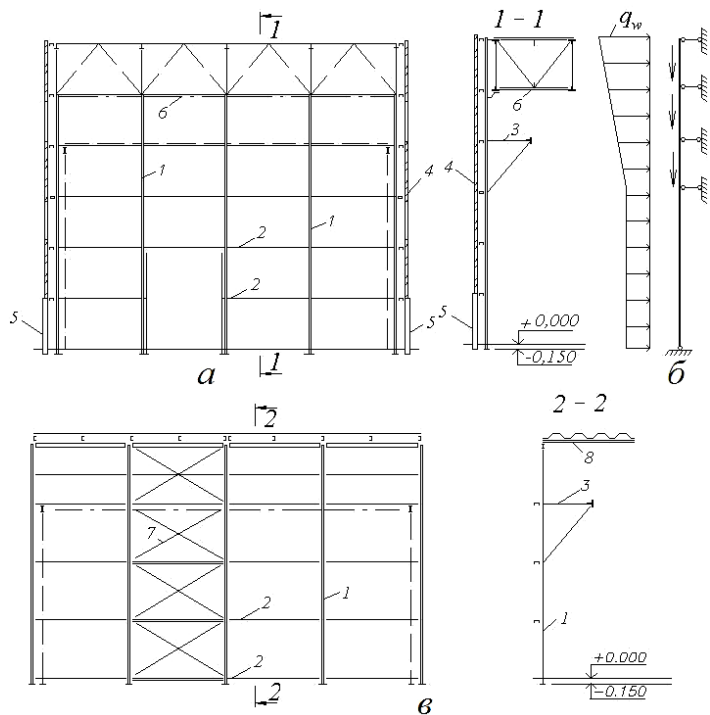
Торцевий фахверк: а – схема самонесучого фахверка; б – розрахункова схема стояка; в – схема несучого фахверка; 1 – стояки фахверка; 2 – ригелі фахверка; 3 – перехідна площадка; 4 – стінове огороження; 5 – цокольна панель; 6 – в'язі по нижньому поясу ригелів; 7 – вертикальні в'язі; 8 – прогони покрівлі
